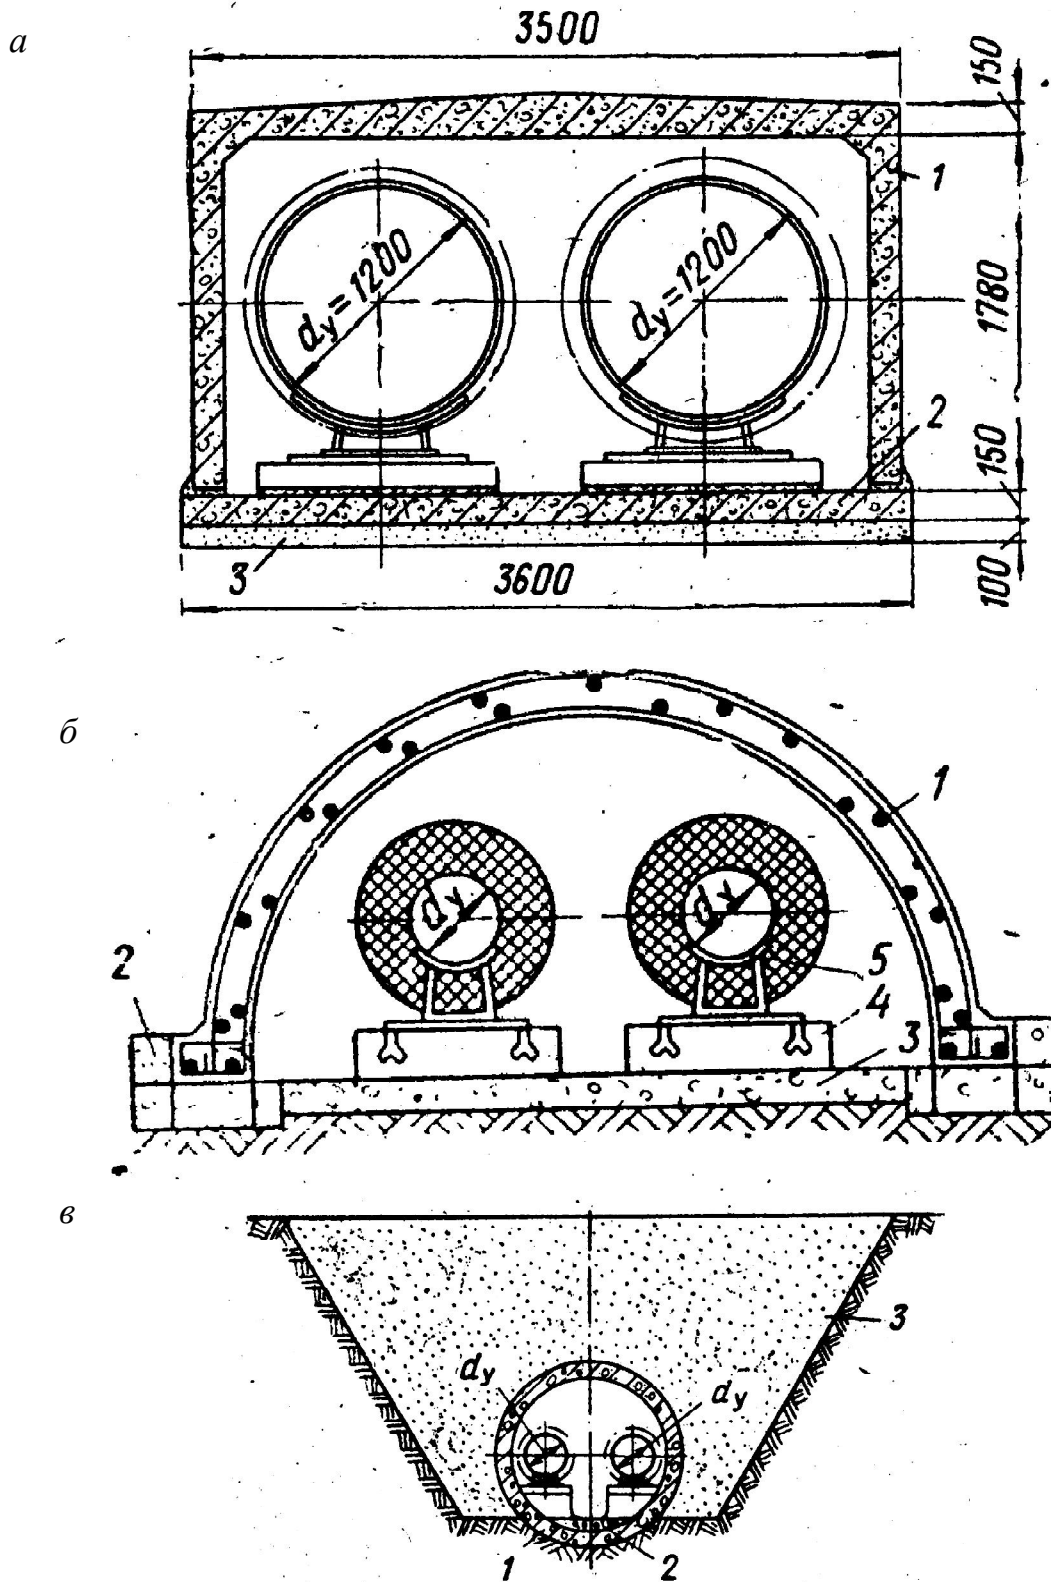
Конструкции каналов: *а* – канал рамной конструкции: 1 – железобетонная рама; 2 – плита-днище; 3 – песок; *б* – сводчатый канал: 1 – железобетонный свод; 2 – бетонный фундамент; 3 – бетонная плита; 4 – опорные плиты; 5 – опоры теплопровода; *в* – полупроходной канал: 1 – железобетонная труба; 2 – бетонный пол; 3 – песчаная засыпка
